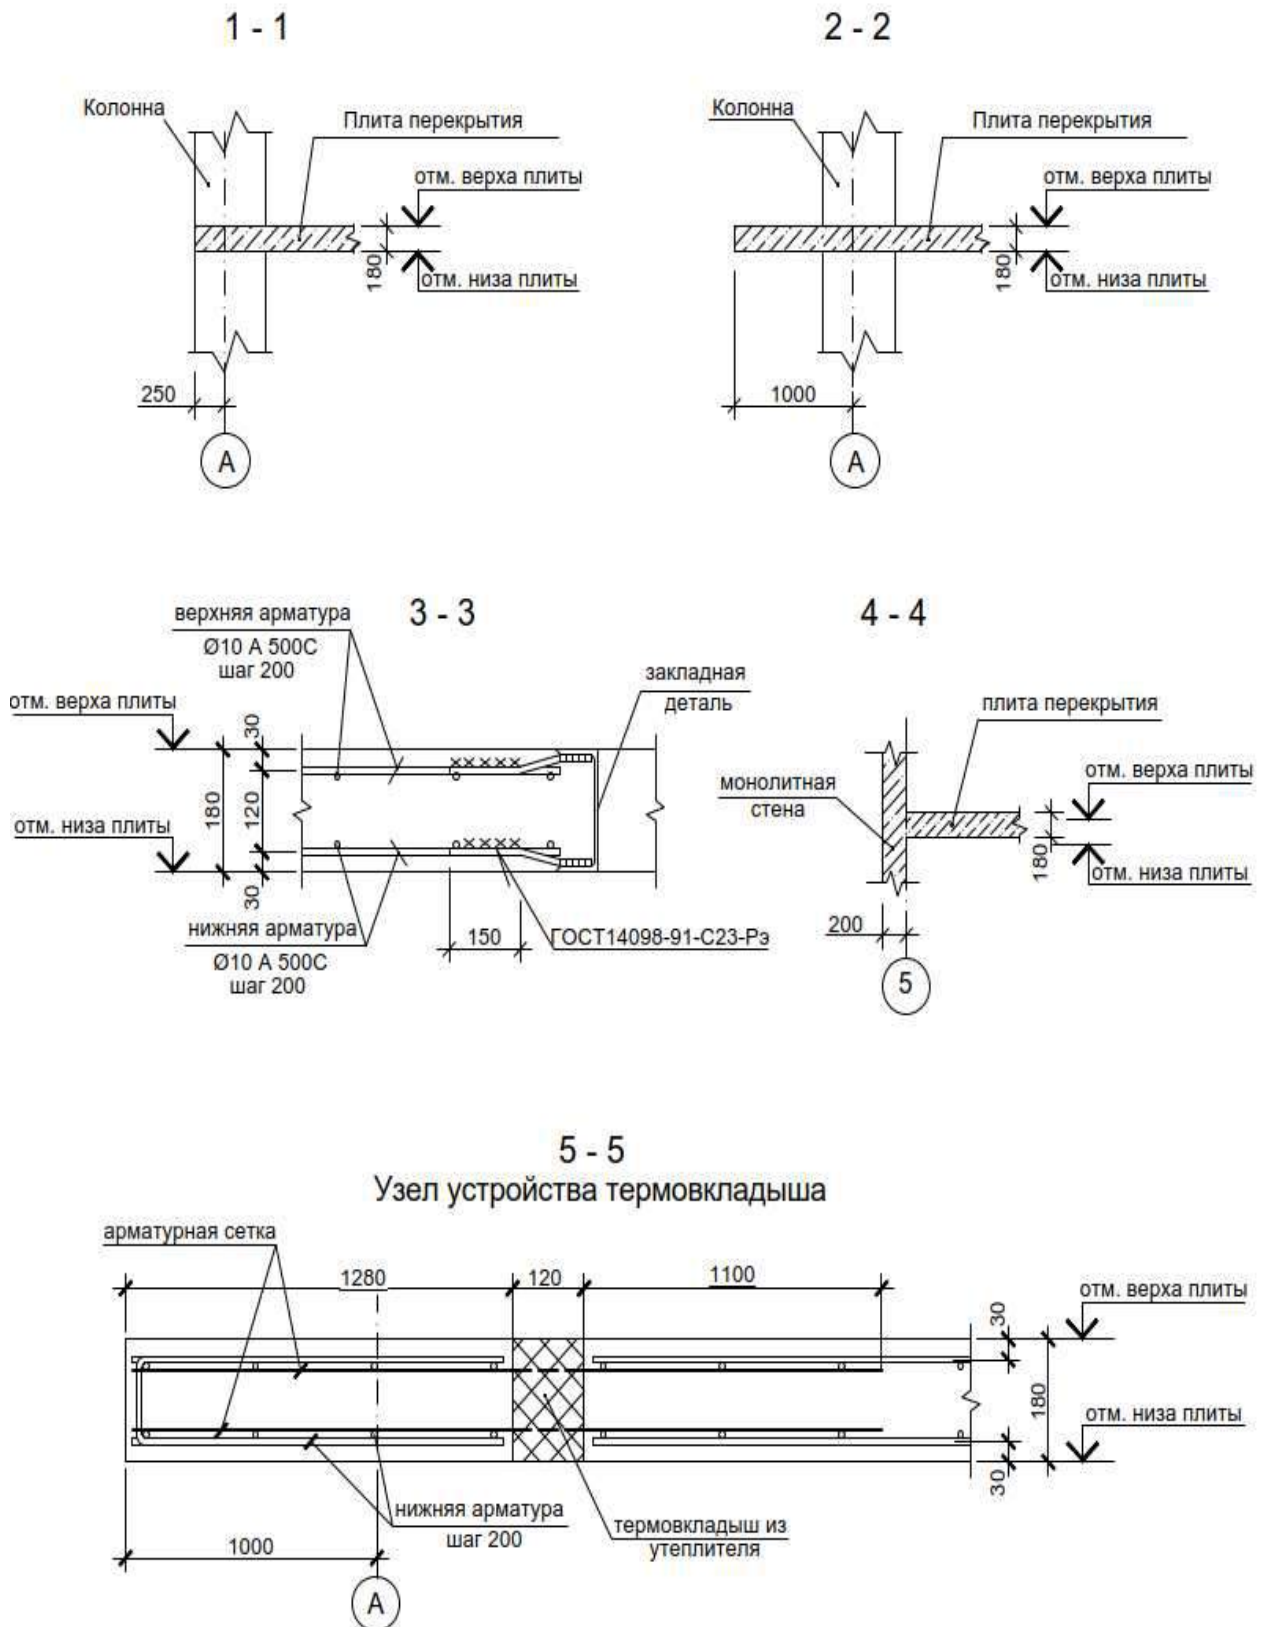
Монолитная плита перекрытия. Опалубка. Узлы.
